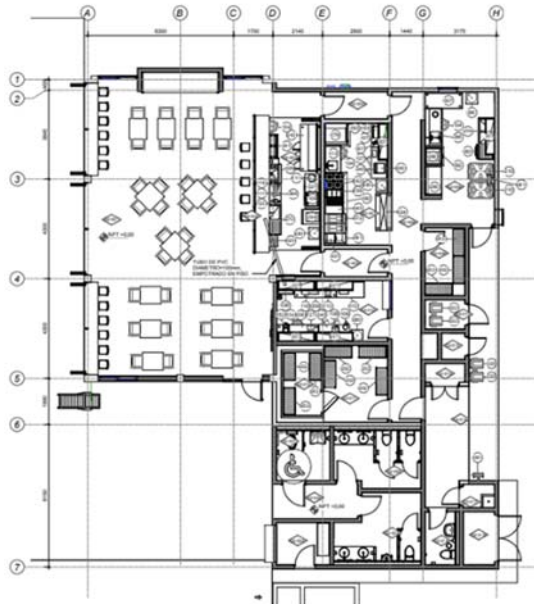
Edificio 02 - Planta arquitectónica nivel +0,00 m
